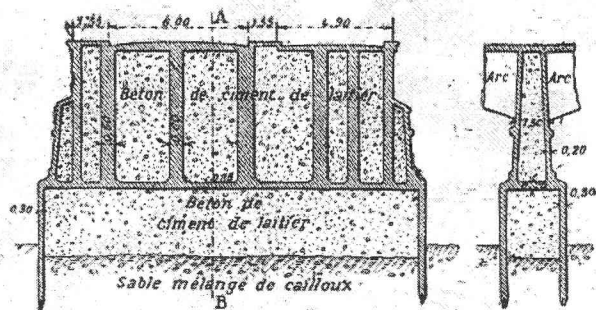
Coupe longitudinale d'une pile projetée sur un plan normal à l'axe du pont.
